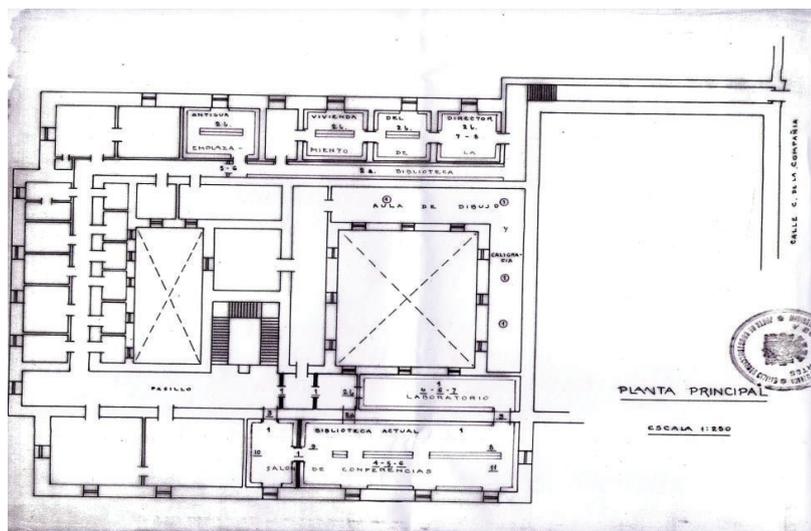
y 16 Planos: Planta principal y baja, 1932. Escala 1:250.
